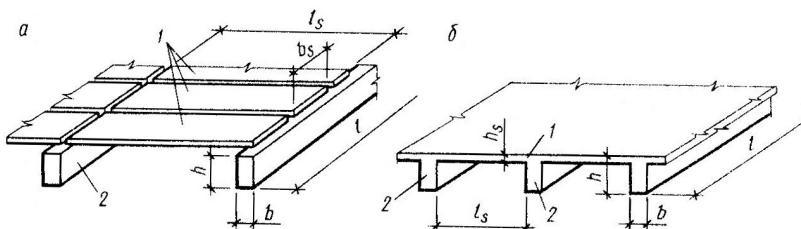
Изгибаемые железобетонные элементы: *a* – сборное перекрытие; *б* – монолитное перекрытие; 1 – плиты; 2 – балки
